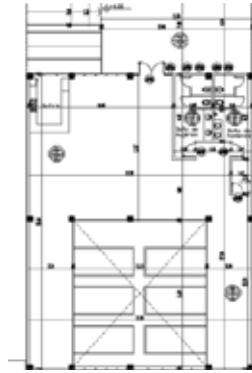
Acercamiento de la Planta Baja Nivel +0.15 m (2018)
